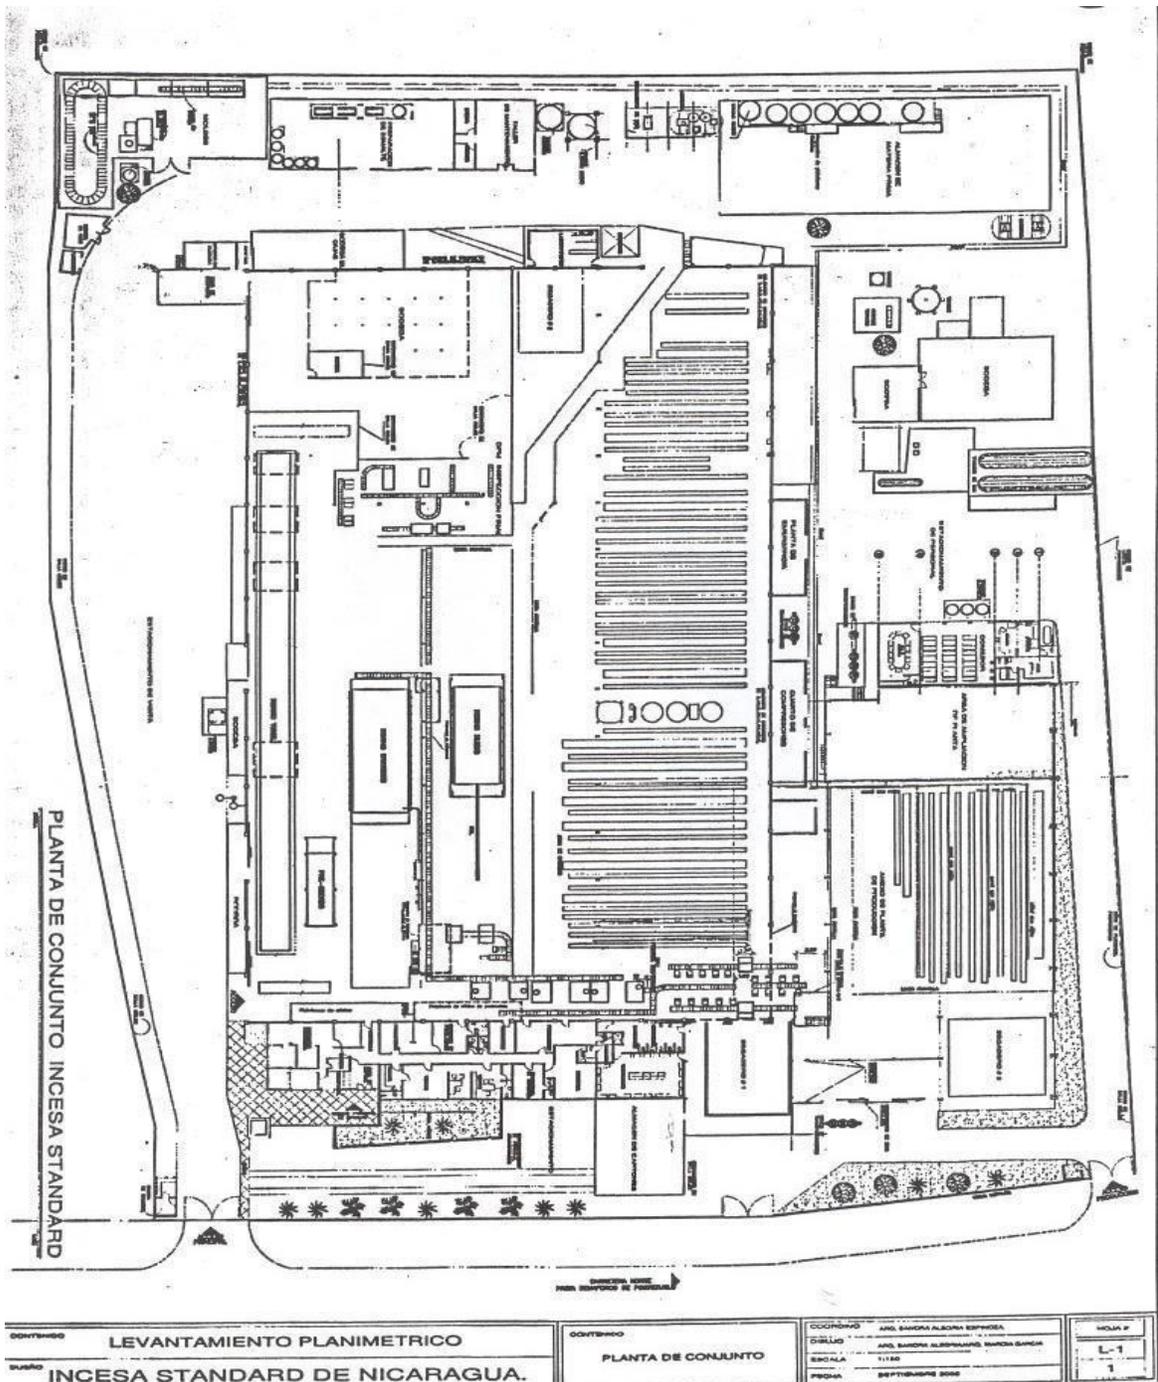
Vista Superior de la Planta, Fuente 131: Incesa Standard
